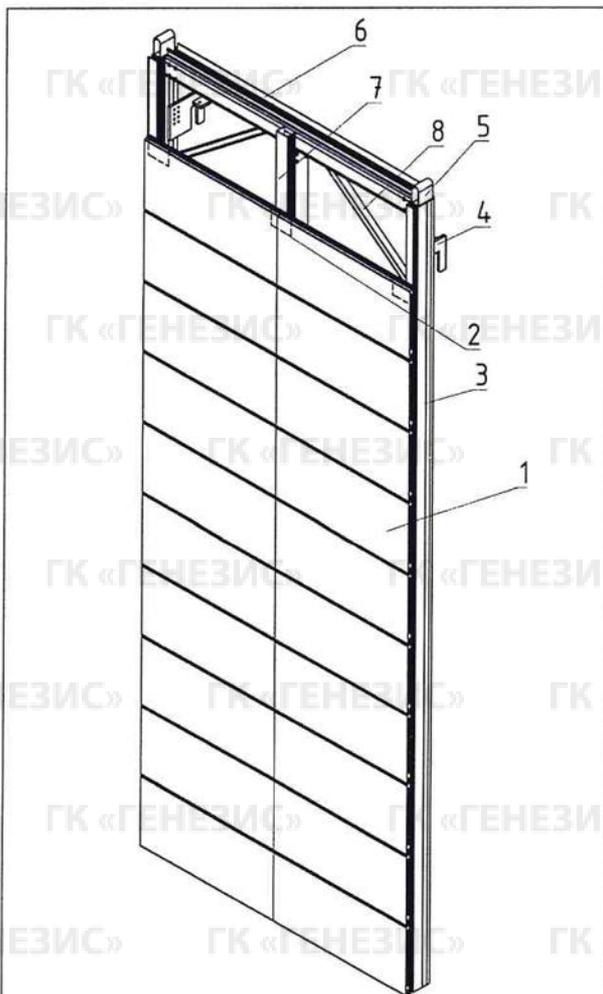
Общий вид модуля G-tech с частично снятой облицовкой
